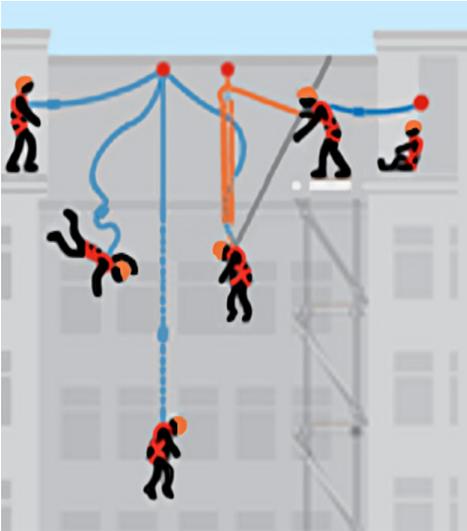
Improvisierte Rettung mit einer Rettungsausrüstung
